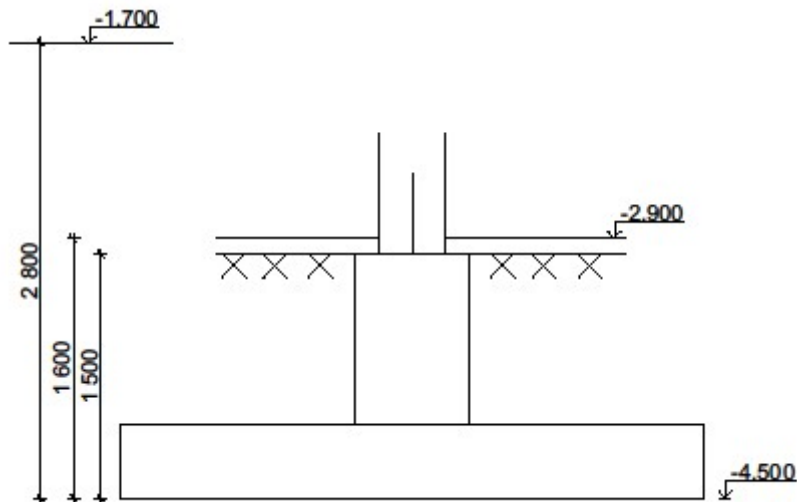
Положення ростверку пальового фундаменту у ґрунті
